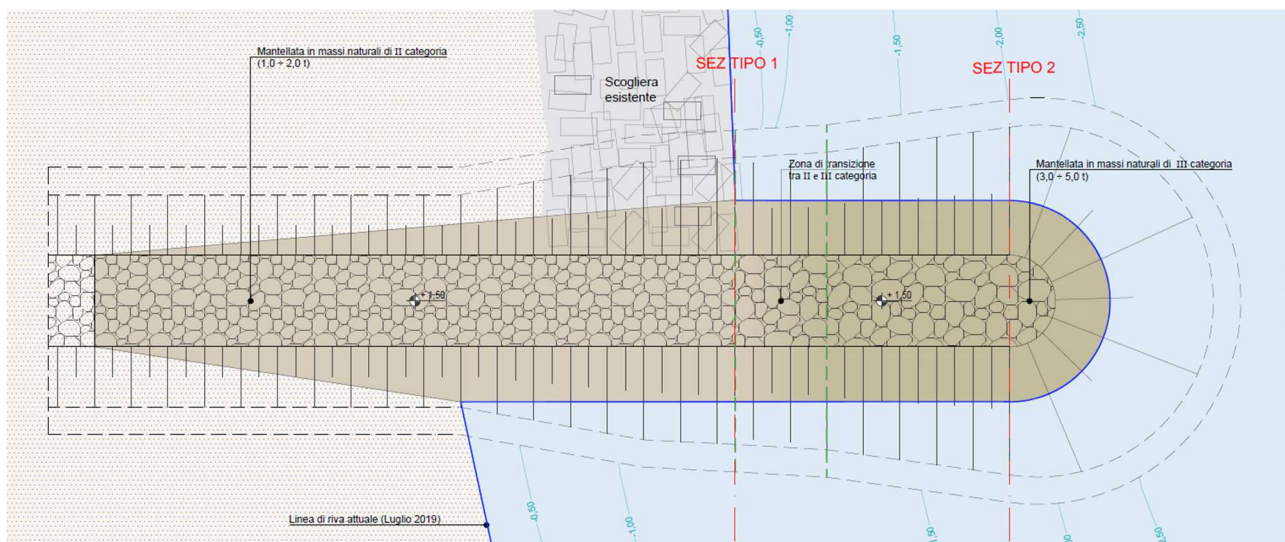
Stralcio planimetrico pennello Marina di Cetraro
